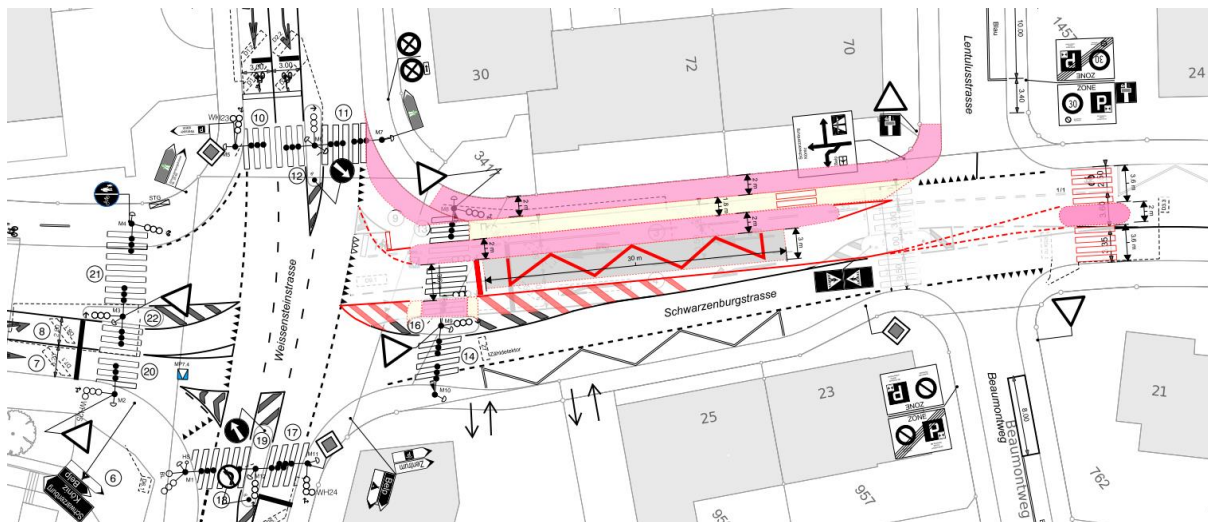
Situationsplan Haltestelle Weissensteinstrasse
